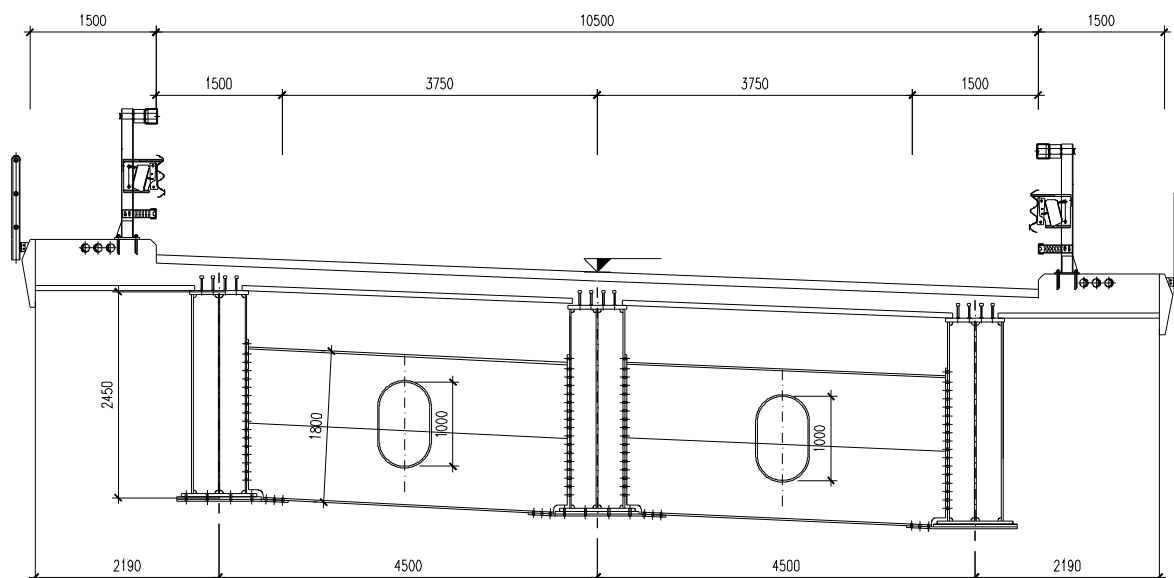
Sezione trasversale tipo impalcato 60m (Appoggio)
